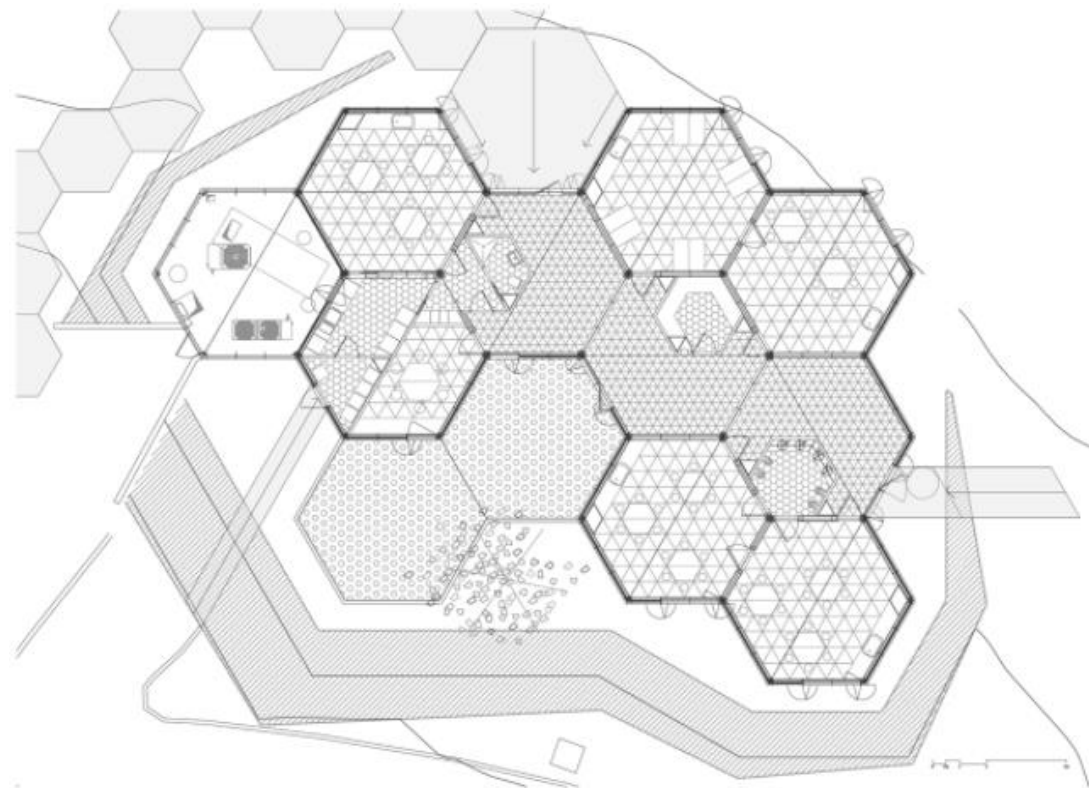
“Planta de la guardería modular por ENERO Arquitectura” [Plano]. Fuente: Ibíd.
